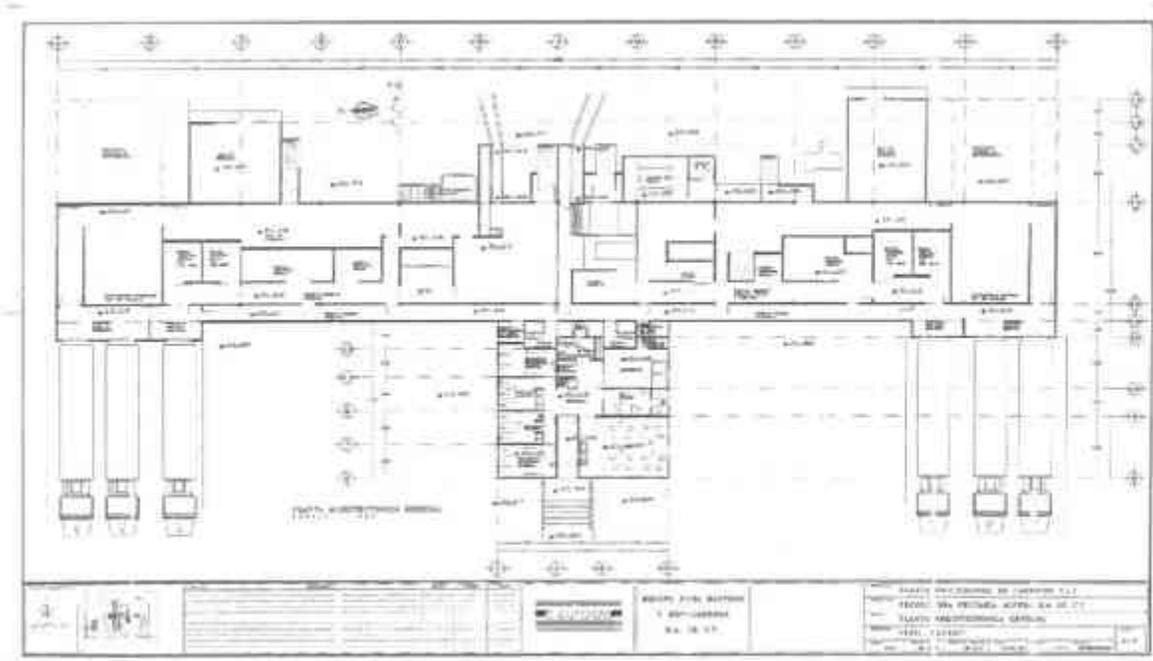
Planos de construcción (plano arquitectónico) Productora Pecuaria ALpera S.A. DE C.V. /29-07-2014.
